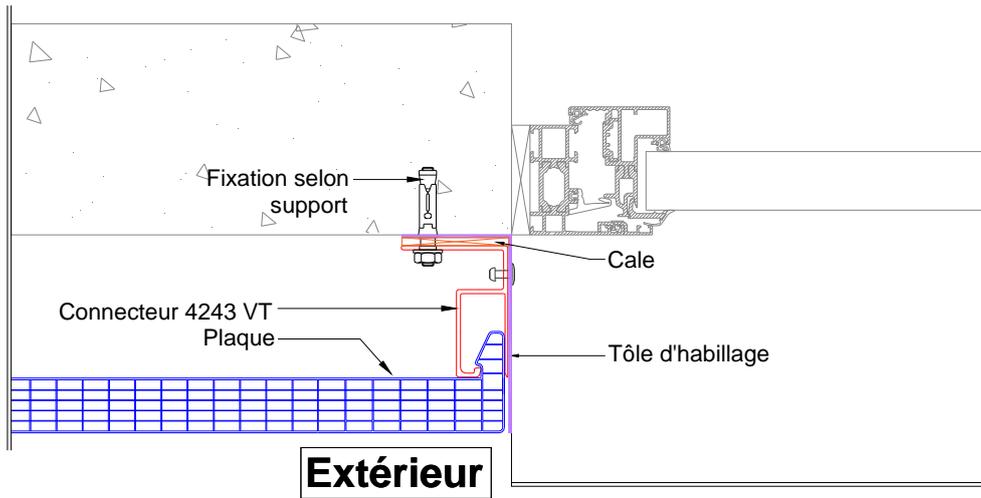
Encadrement d'une baie en tunnel avec plaque ajustée – Coupe horizontale
